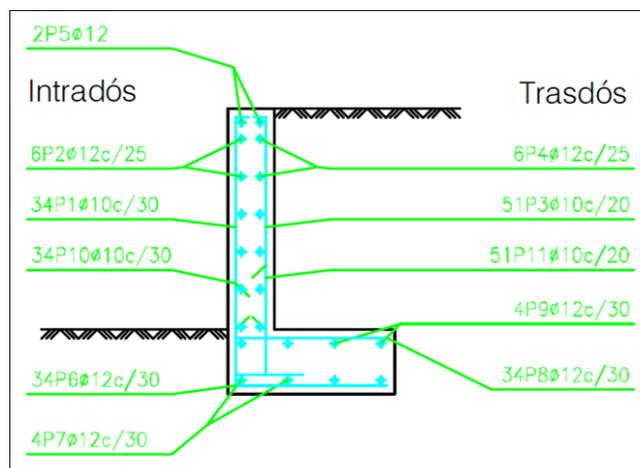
Detalle de armaduras de ambos muretes de hormigón armado.
